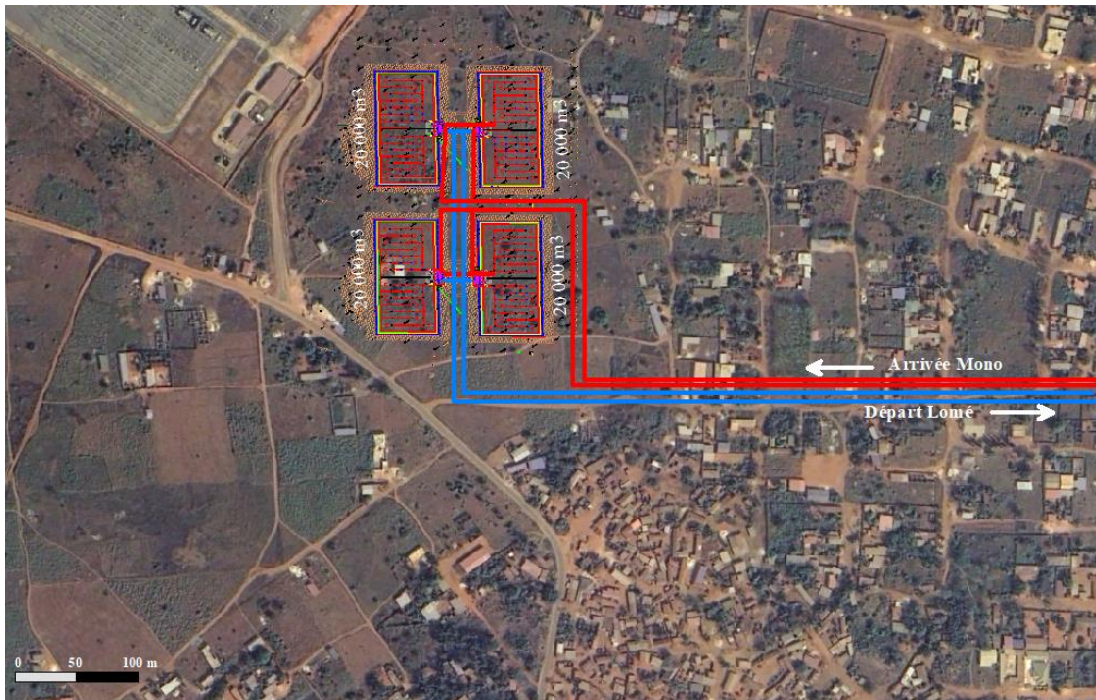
Ouvrages projetés – Site de Kovié (~15 000 m<sup>2</sup>)
